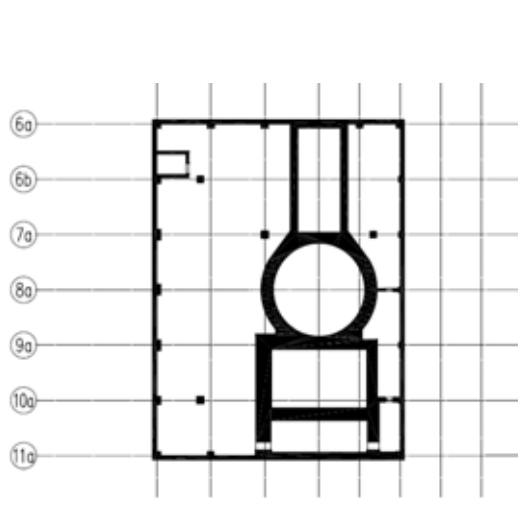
1号機原子炉建屋の損傷状況（立面図）
